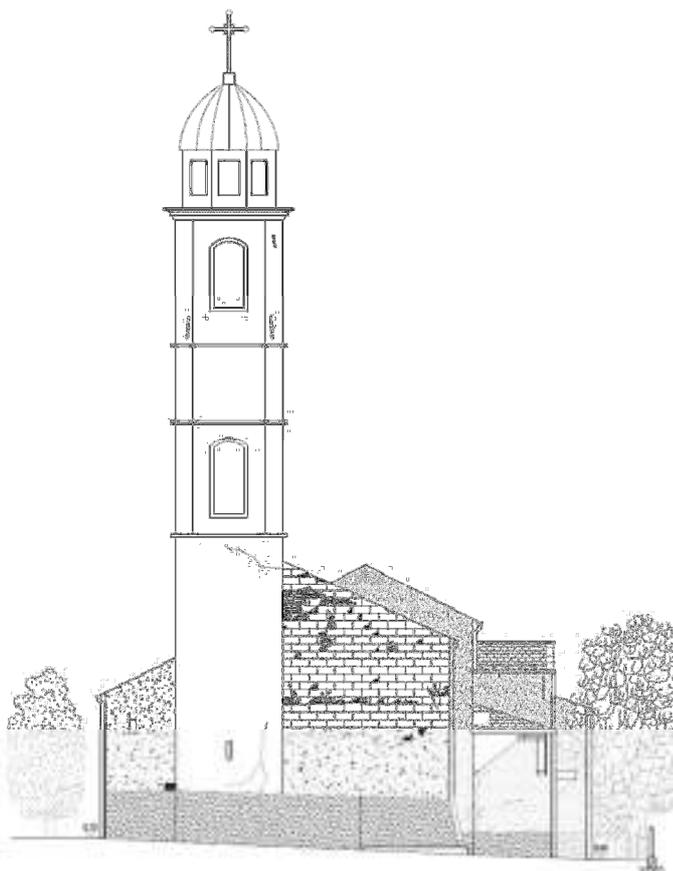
Prospetto posteriore sud (Fonte: Tavola 3D)
